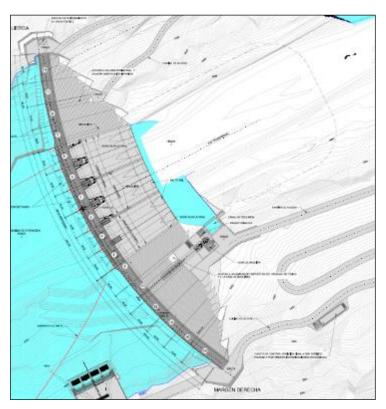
Planta de la Presa – Ingeniería Básica Extendida (Fuente: CRM)
